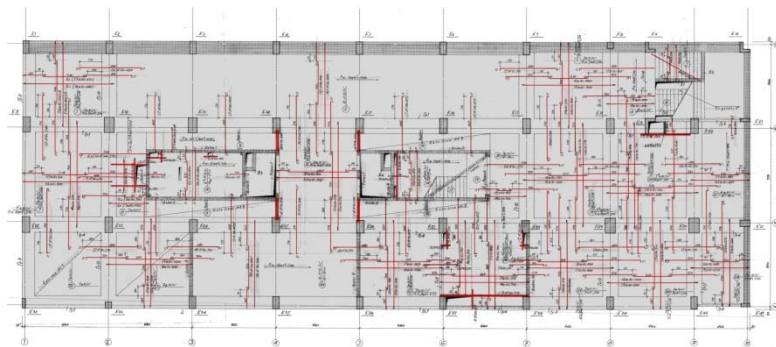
Котражен план на плоча – кота 549,94 на блок 2 на УАСГ
